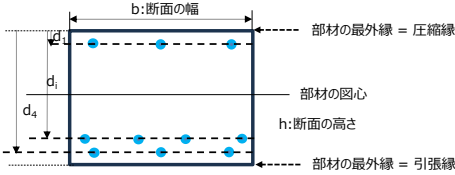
鉄筋コンクリート部材断面、鉄筋配置模式図
